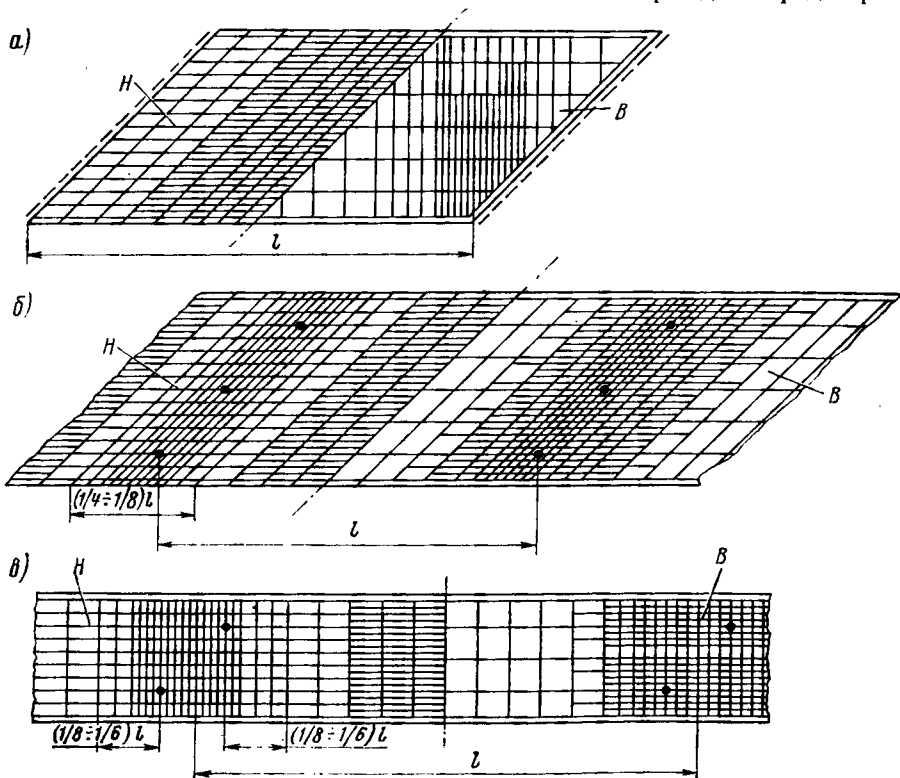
Схема армирования косых плитных пролетных строений ненапрягаемой арматурой:
